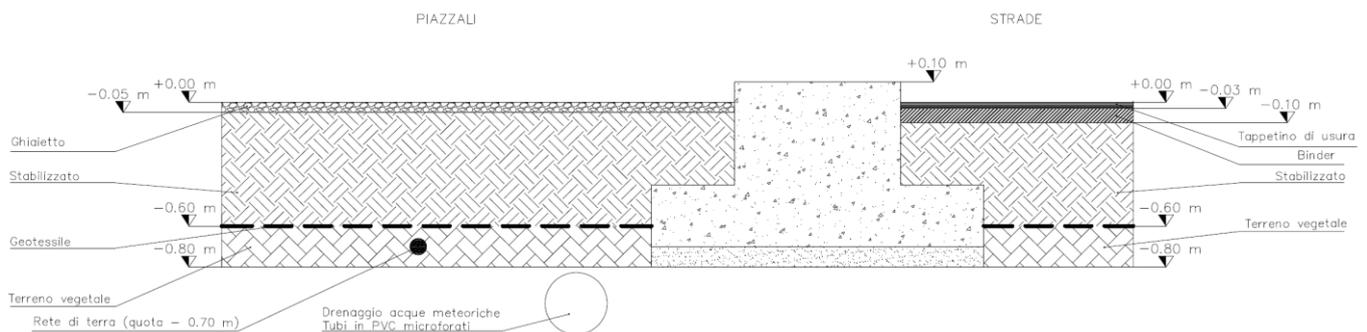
Sezione tipo piazzale e strada di circolazione all'interno della stazione elettrica
